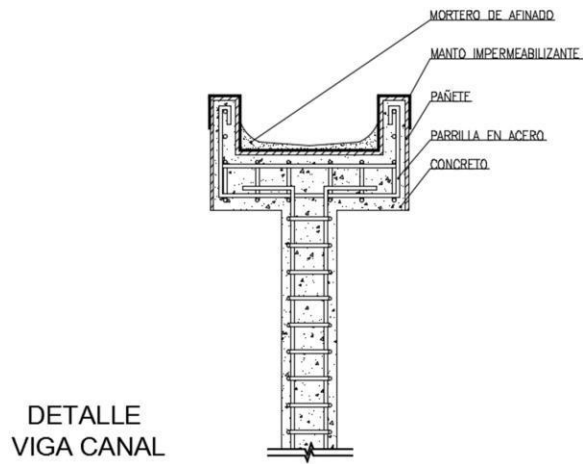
Detalle Viga Canal, Instituto de aprendizaje técnico de Leyva
